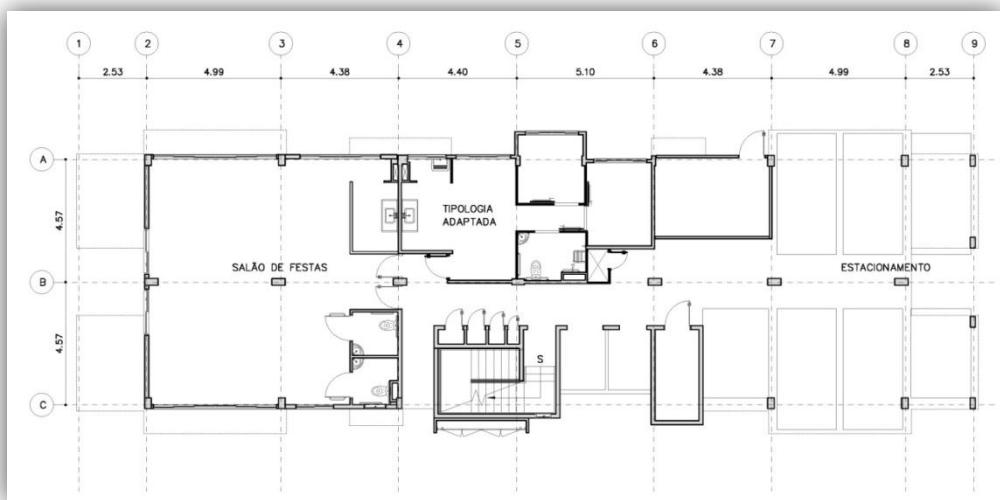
V052-3 – Planta do pavimento térreo; sem escala.
